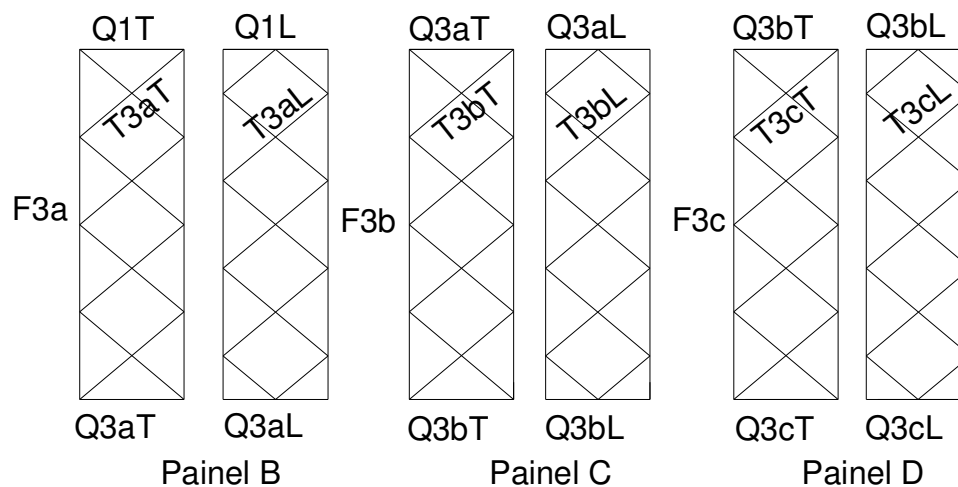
Detalhe da localização dos perfis estruturais na torre estaiada – Painel B, Painel C e Painel D.
